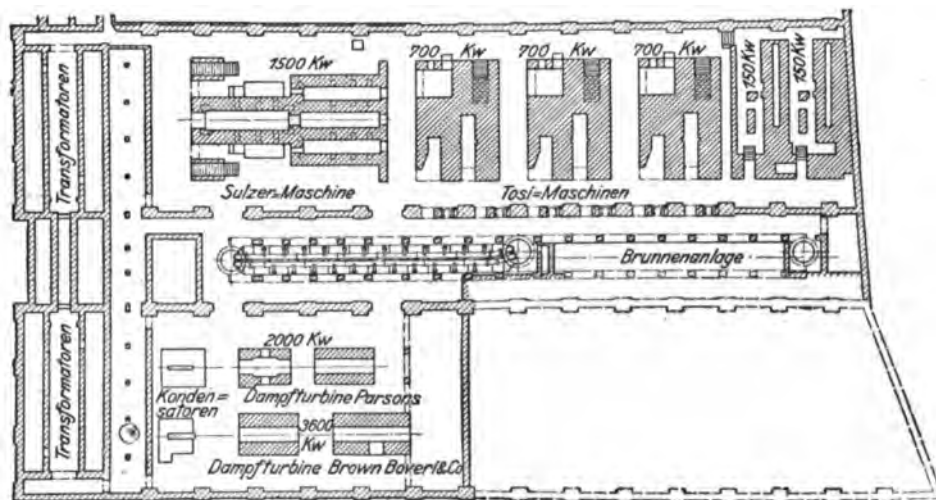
Plan des fondations de l'Usine de la Porta-Volta.
